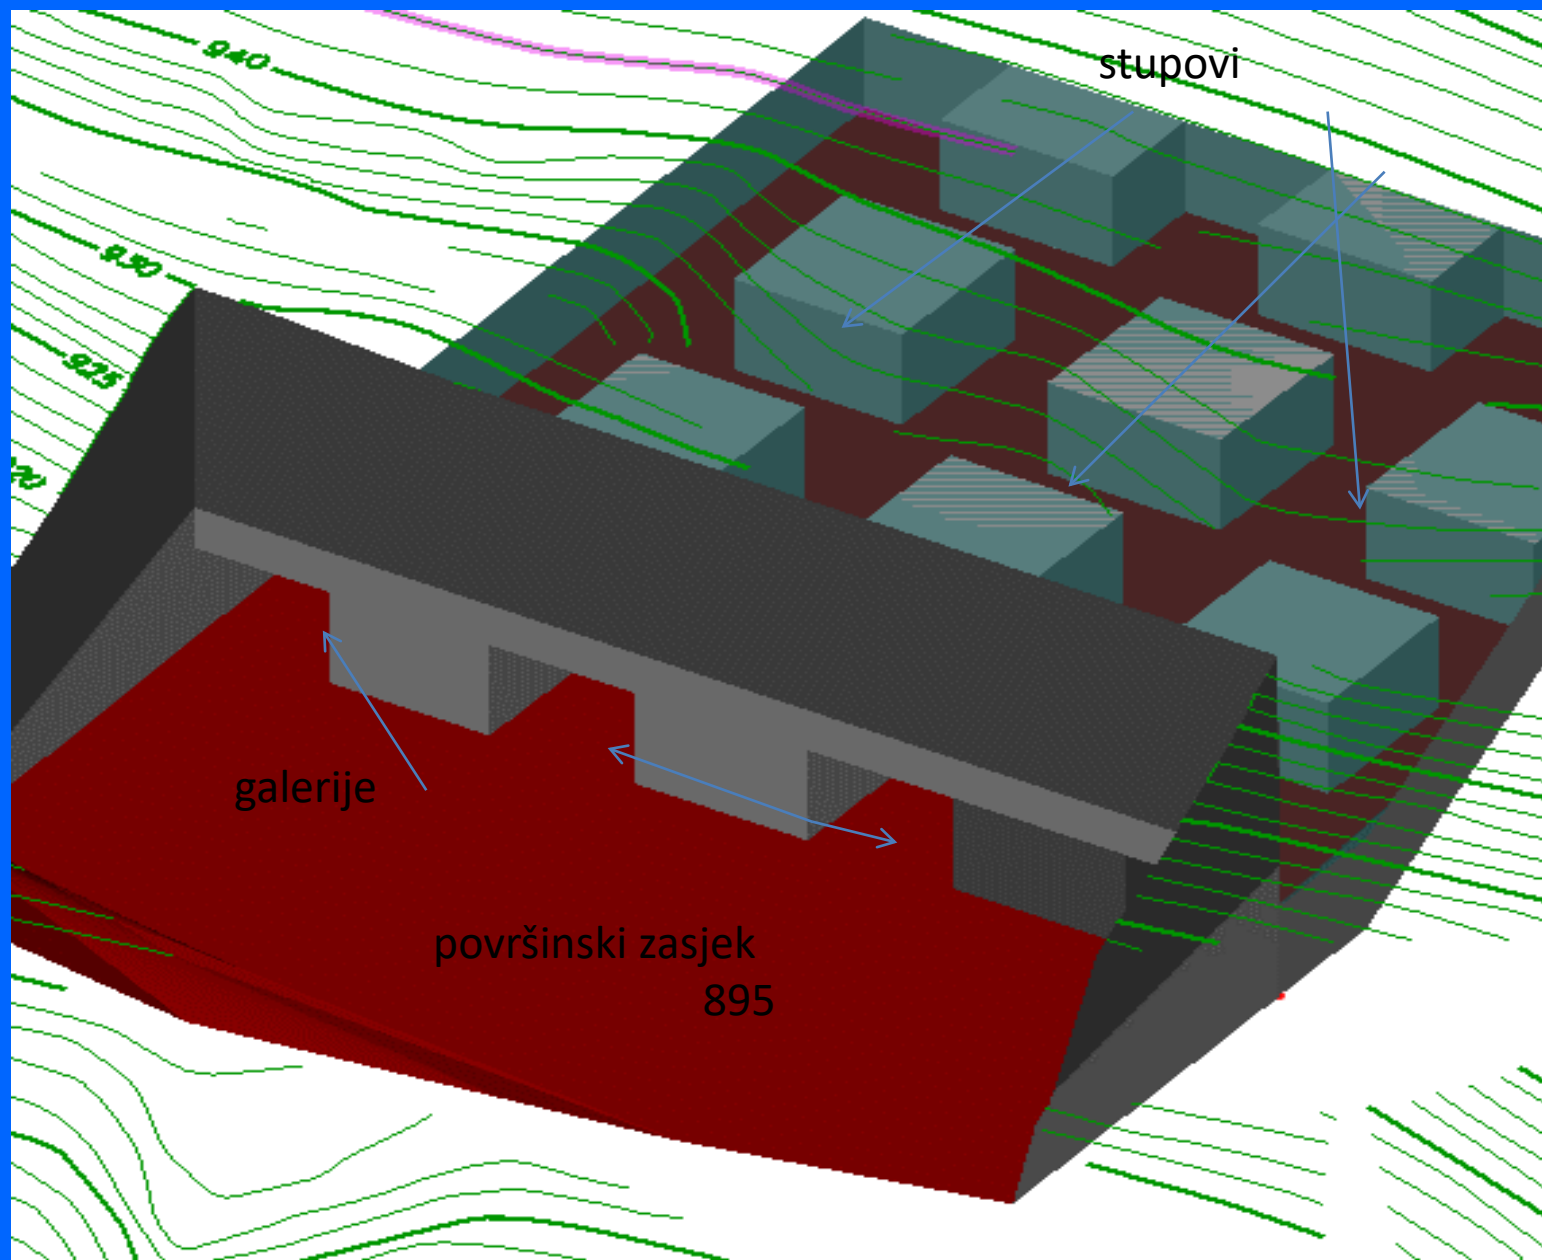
Priprema terena s planom izrade galerija (C.S.)
